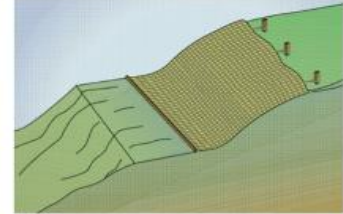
Escavação protegida - com estruturas descoláveis "cortinas"
